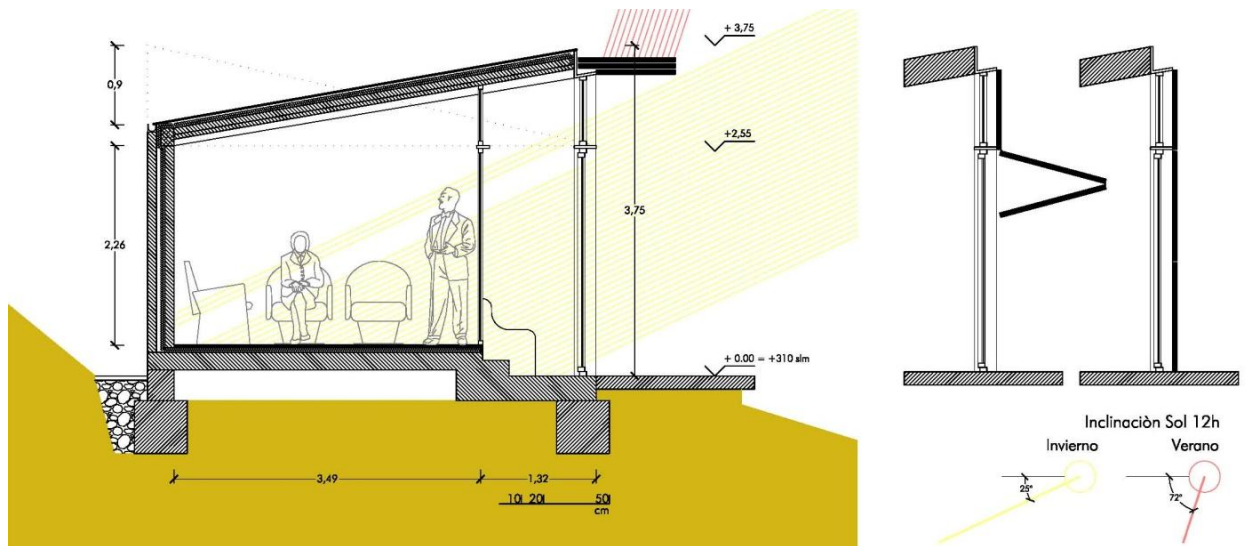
Sección transversal en el invernadero. Se notan los tres tipos de tejado y el detalle de los porticones
